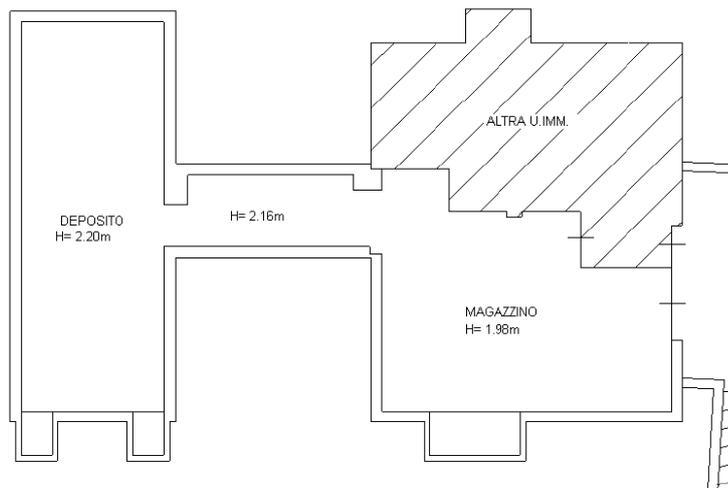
Estratto planimetria catastale, relativa al magazzino sub. 10
